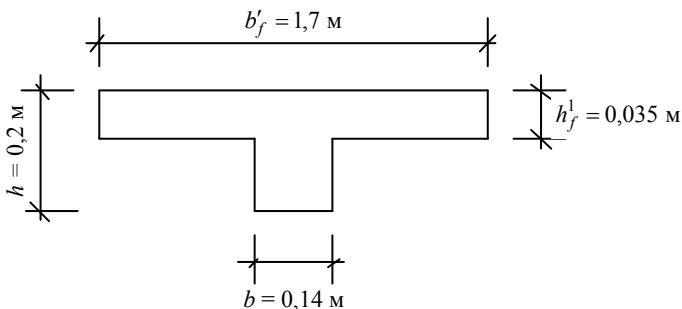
Расчетное сечение при расчете продольных ребер плиты
